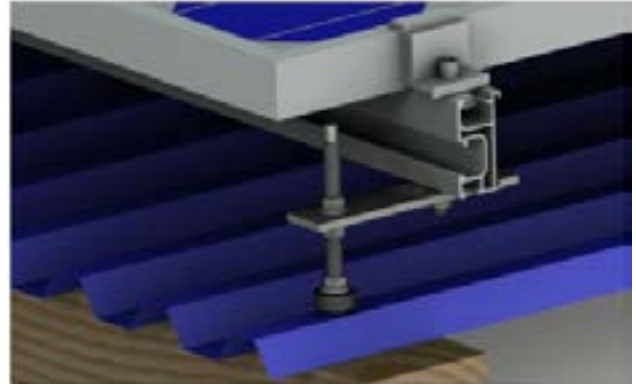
Elemento de fijación de estructuras de montaje de paneles solares en cubierta
